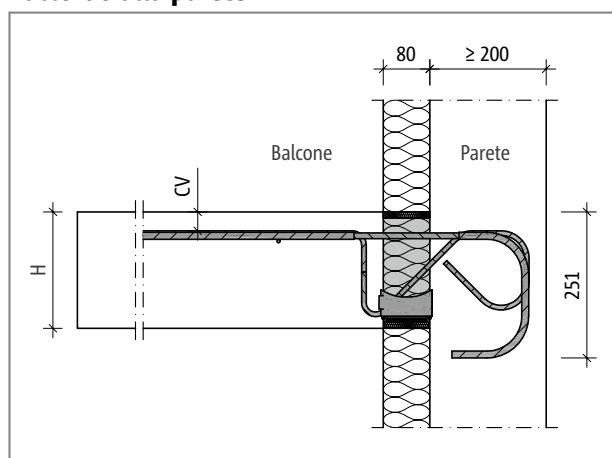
Schöck Isokorb® T tipo KL-O-M8 - KL-O-M12: raccordo alla parete con isolamento esterno
